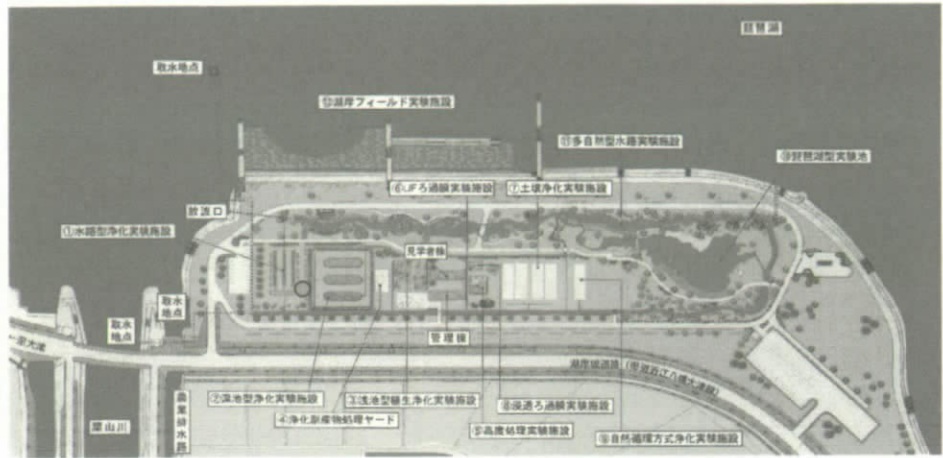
実験センター平面図 (●: 実験施設設置地点)
